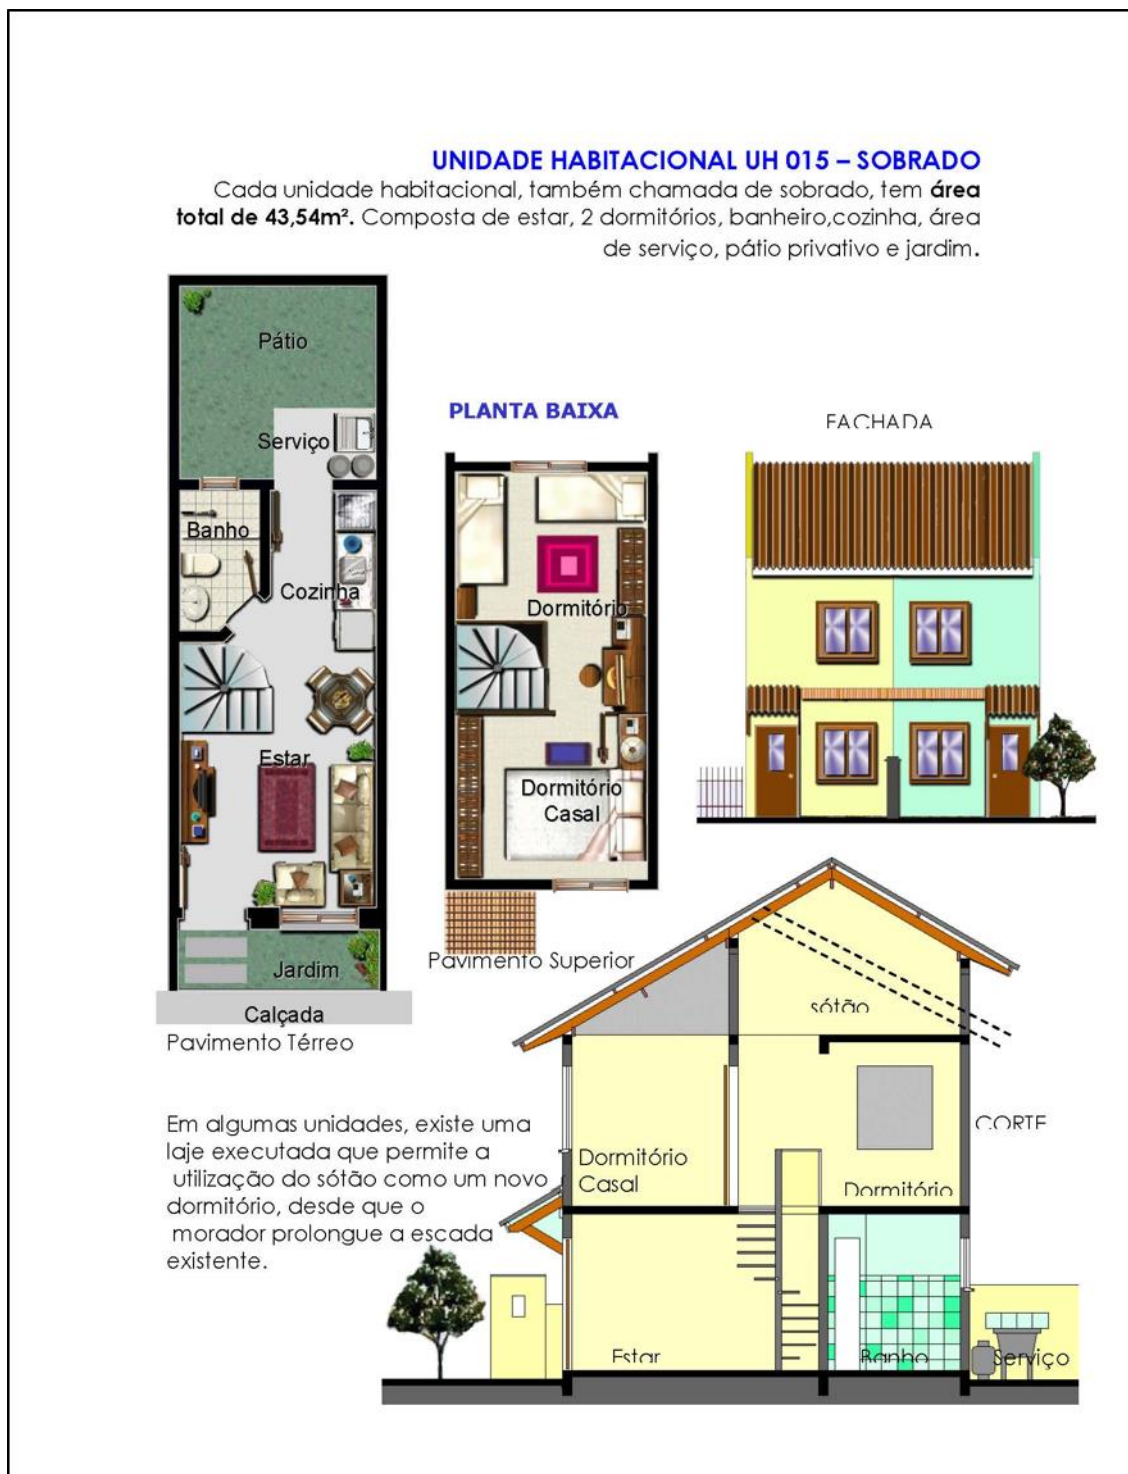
Planta baixa sobrado – Loteamento Santa Terezinha. Fonte: Acervo DEMHAB, 2007.
